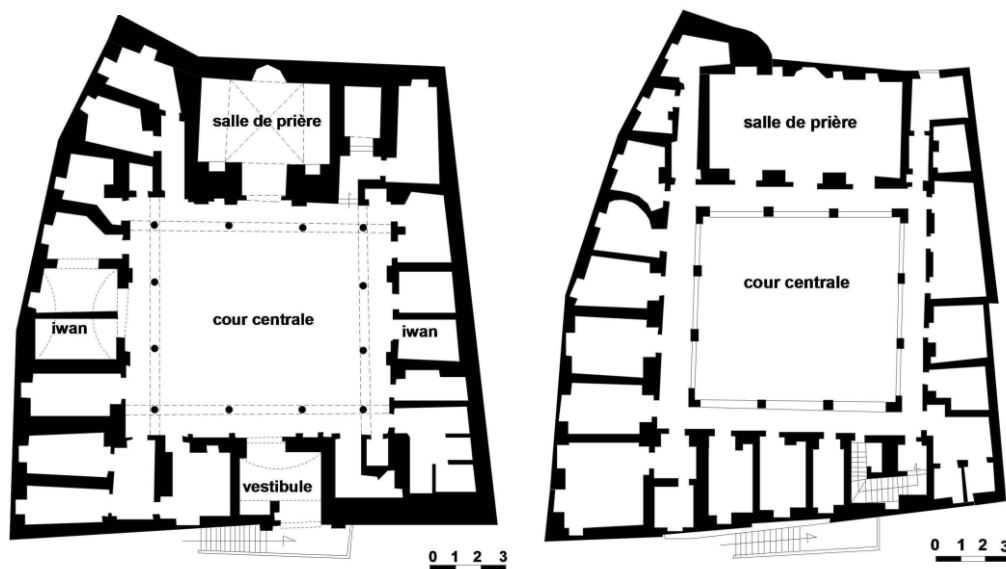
Vues en plan de la medersa ech-Chammā'iyya : Rez-de-chaussée à gauche et premier étage à droite.
